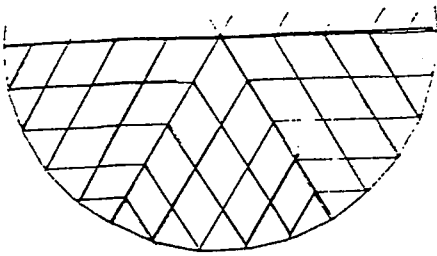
Baklava Kubbelerin plan ve görünüşleri
